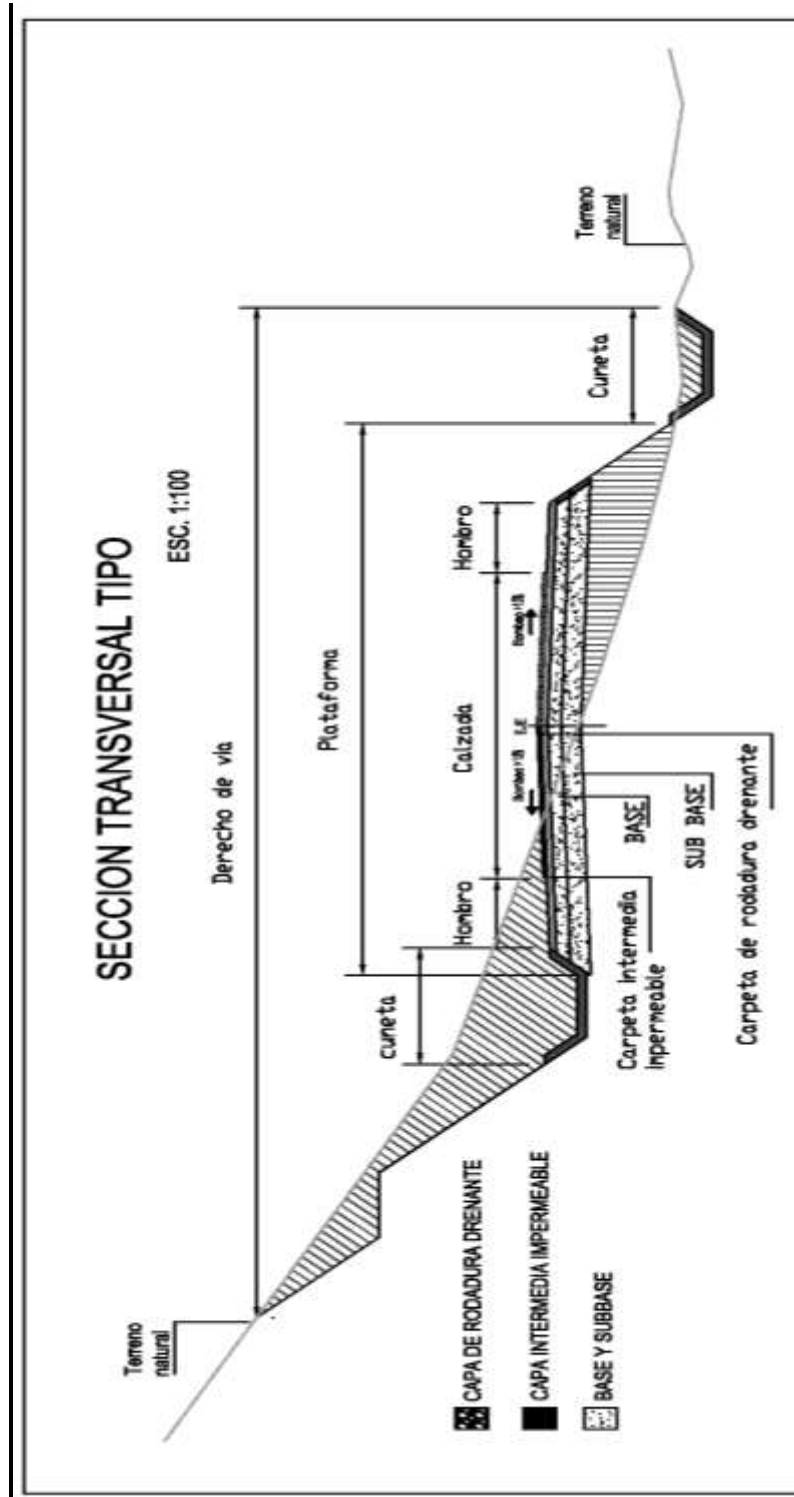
Sección Transversal Tipo de un Pavimento Provisto con Capa de Rodadura de Mezcla Asfáltica Drenante
